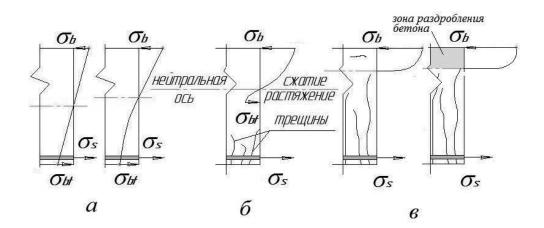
Стадии напряженного состояния изгибаемой железобетонной балки по нормальному сечению: a — начальная;  $\delta$  — промежуточная;  $\delta$  — финальная
